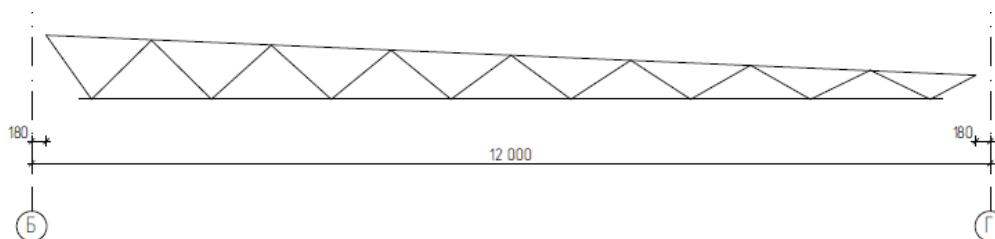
Схема подстропильной фермы (ФС2)
